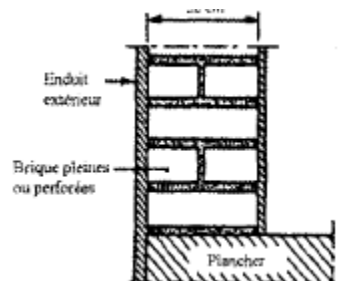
Epaisseur minimale d'une paroi simple de maçonnerie de brique pleine de terre cuite, de BTS, de plâtre, silico-calcaire,
